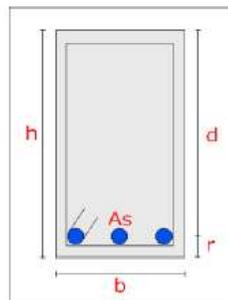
Cálculo de vigas para reforzamiento, (imagen propia).
